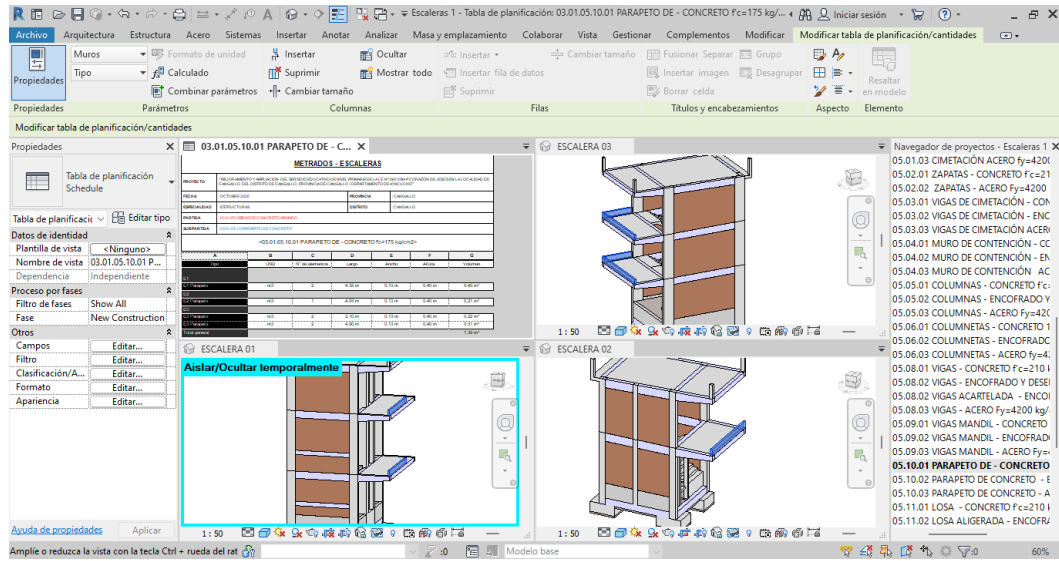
Modelado y metrados de la partida parapeto de concreto Modulo Escaleras.
